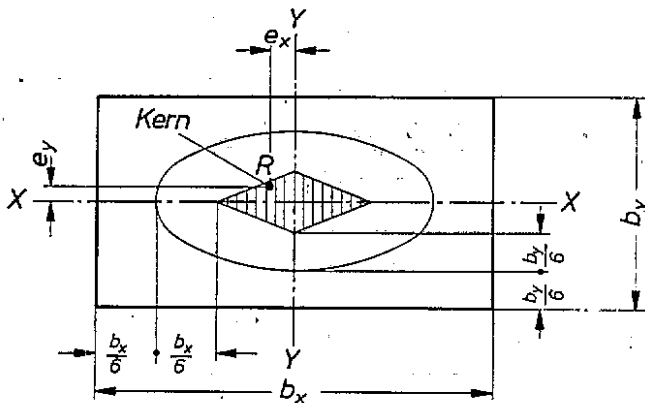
Grundriß eines rechteckigen Fundaments; Bezeichnungen bei zweiachsiger Verkantung
